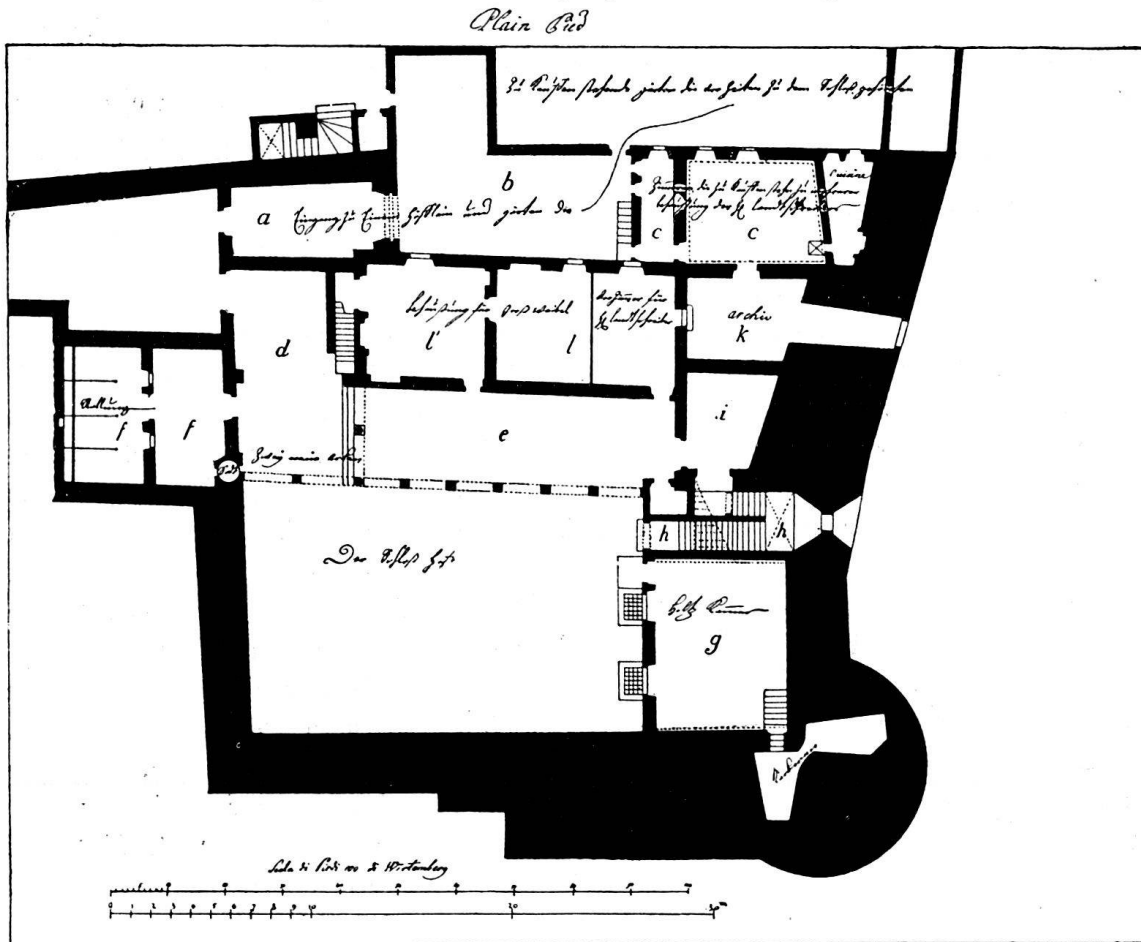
Schloss Locarno. Grundriss von 1752 oder 1753 im Staatsarchiv Luzern.
